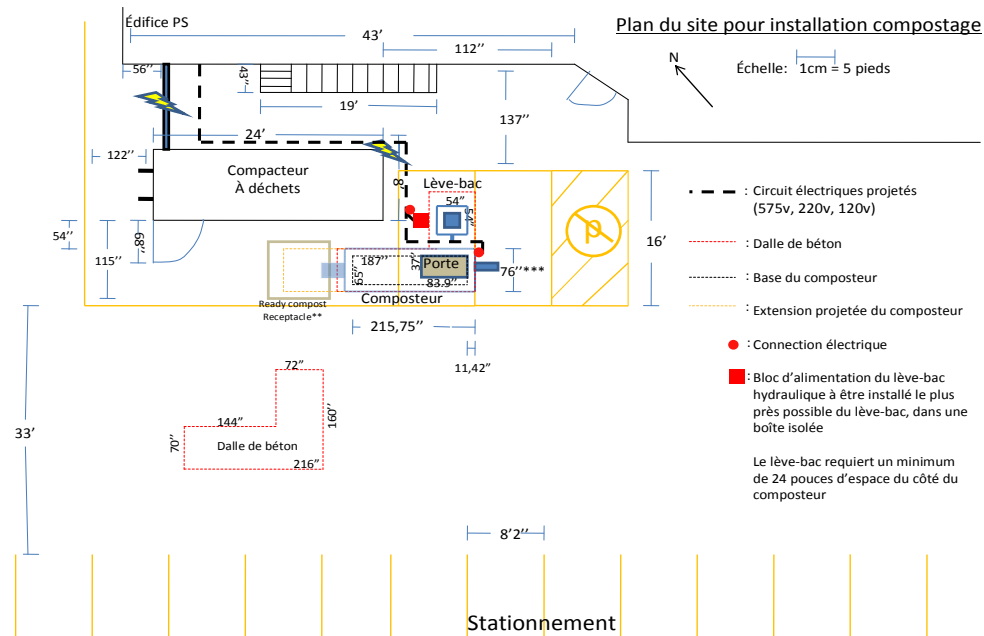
Exemple de plan d'une installation de compostage *in situ* (Illustration Alexis Fortin).
